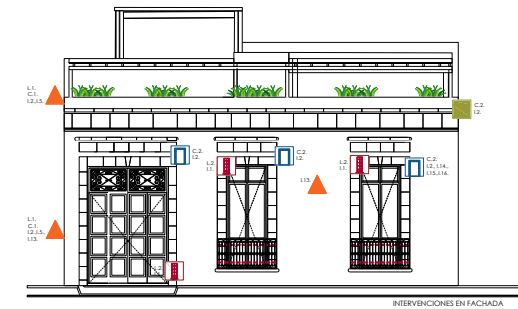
Fachada con iconos y claves que indican las acciones de restauración que se plantea llevar a cabo, de acuerdo al proyecto que se propone. Fuente: Elaboración propia
